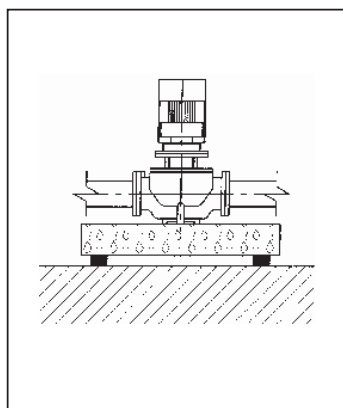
Пример размещения насоса TPV на бетонном фундаменте.
